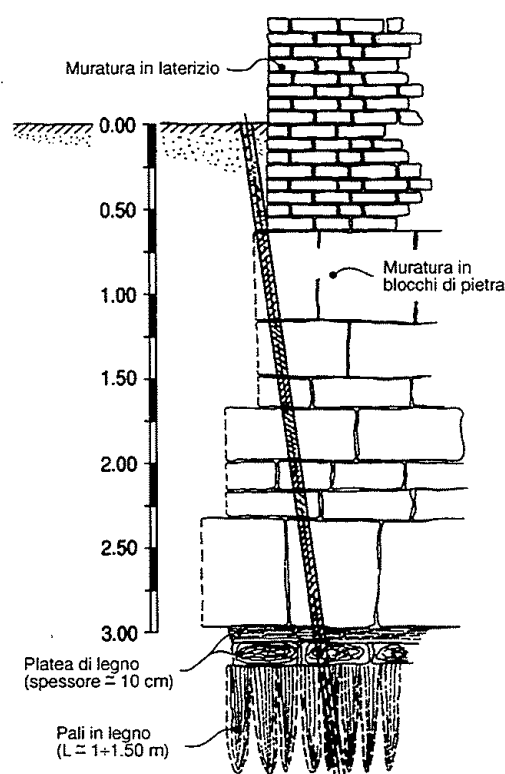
Schema strutturale delle murature di fondazione dei muri perimetrali e dei pilastri della Basilica
